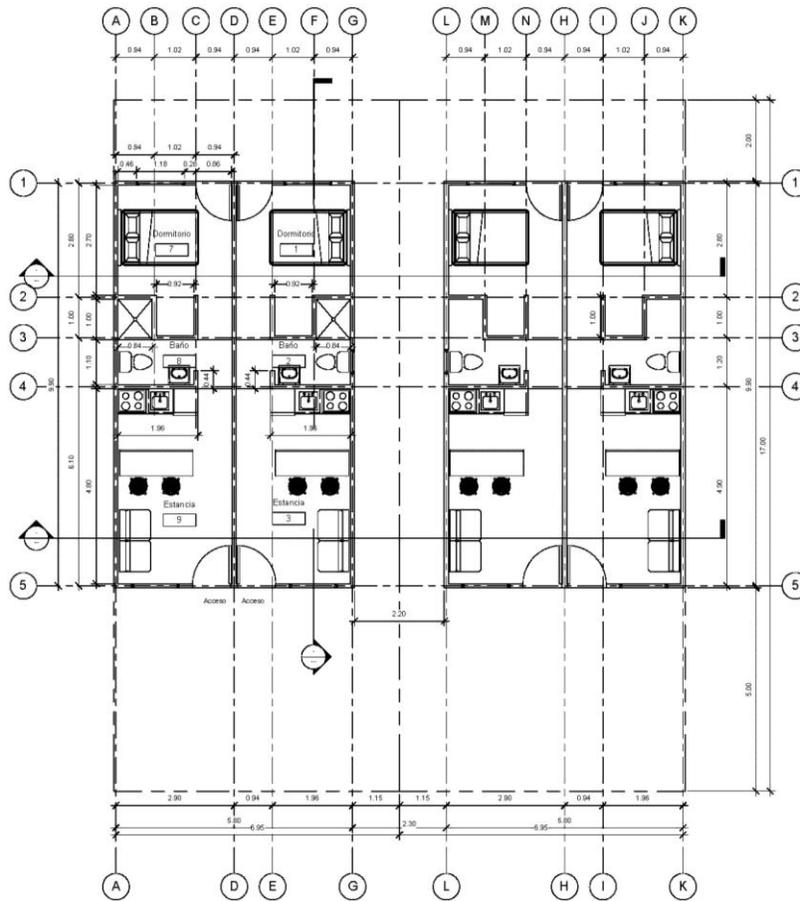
Planta arquitectónica dúplex en terreno de 54.82m<sup>2</sup>
